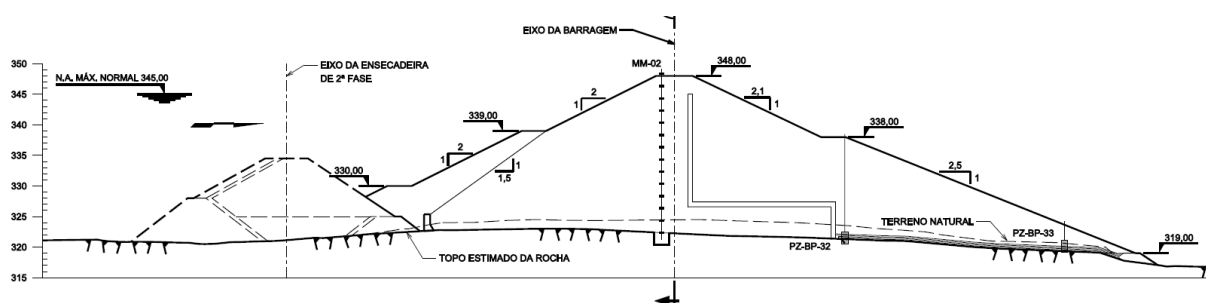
DESENHO ESQUEMÁTICO DO CORTE DA BARRAGEM
